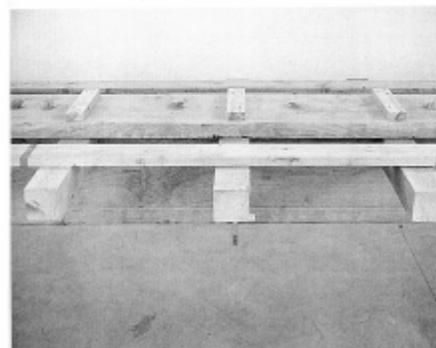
Prospetto laterale della trave consolidata, in corrispondenza della mezzeria. All'estradosso si notano i connettori lignei che collegano la tavola aggiunta al corpo della trave esistente.
